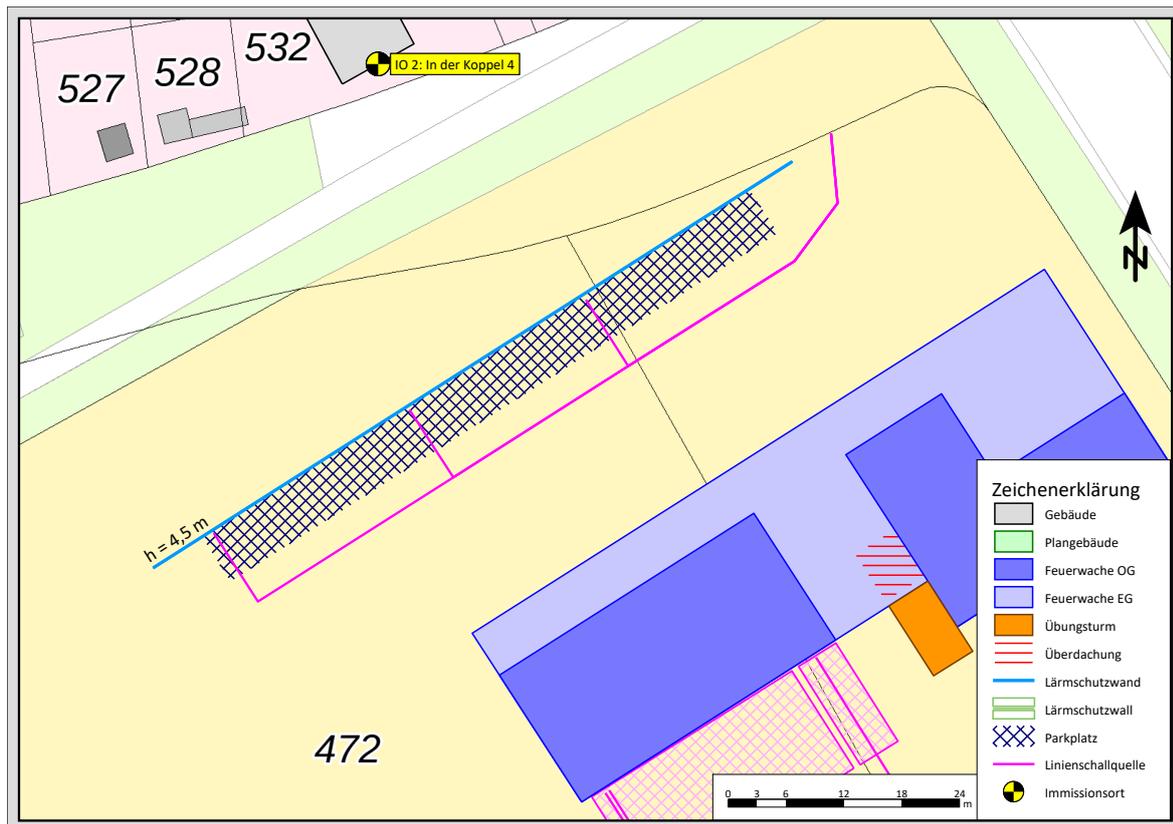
Ausschnitt aus Lageplan der Feuerwache [4] mit Lage der zu errichtenden Lärmschutzwand
